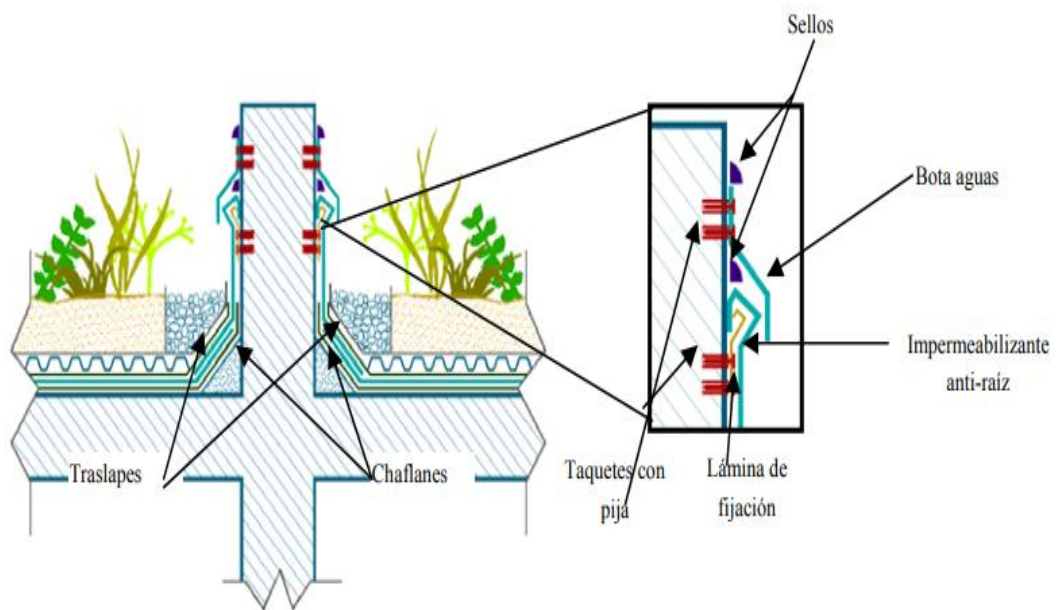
Sección cubierta verde con encuentro de pilar www.ordenjuridico.gob.mx
